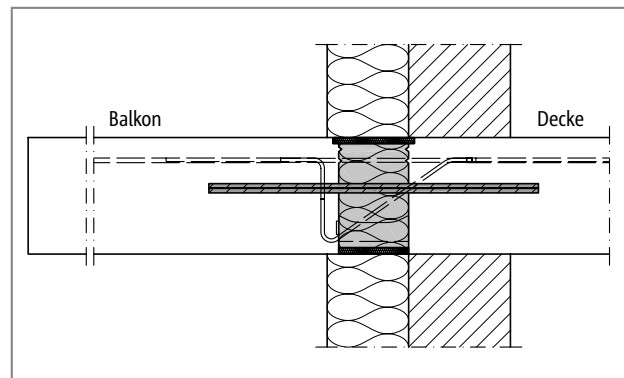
Schöck Isokorb® XT Typ K, HP-VV: Mauerwerk mit Außendämmung
